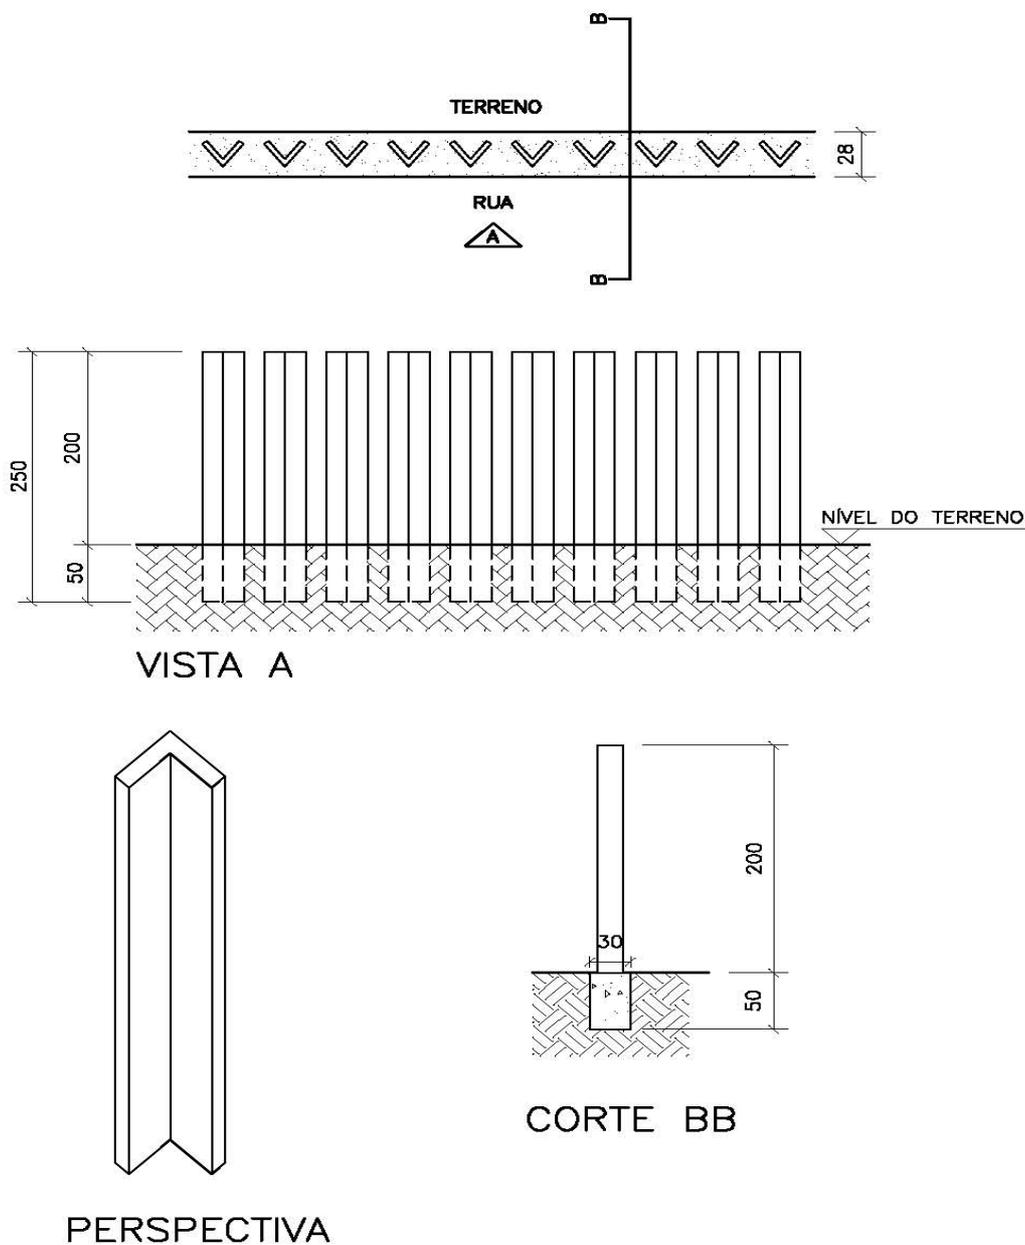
Muro pré - moldado de concreto tipo calha “V”
